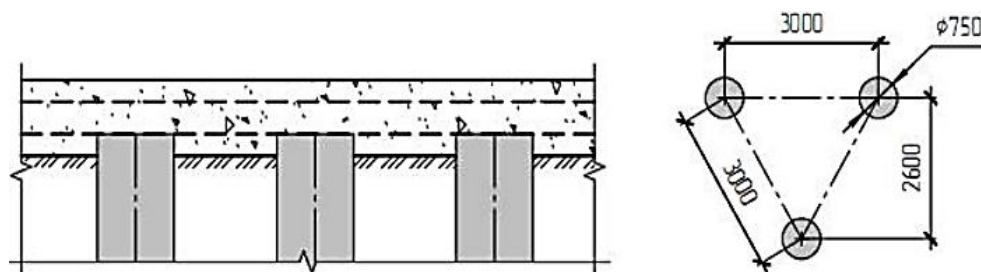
Схема укрепления основания грунтоцементными колоннами
